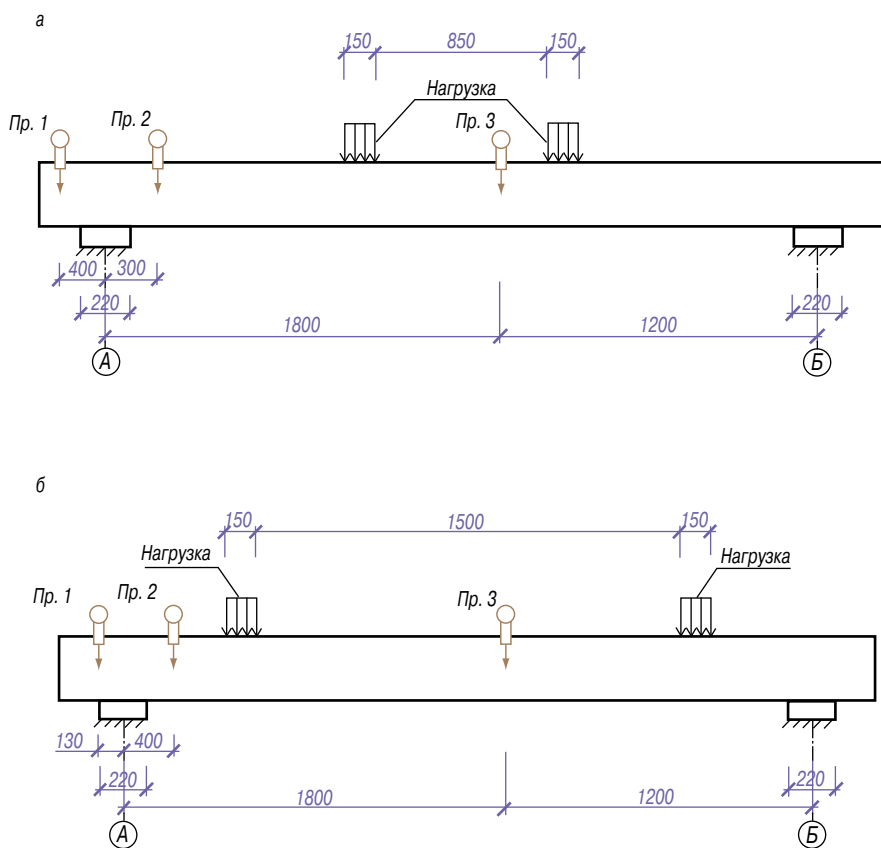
Схема испытания балочных образцов: а – балка Б-1; б – балка Б-2
